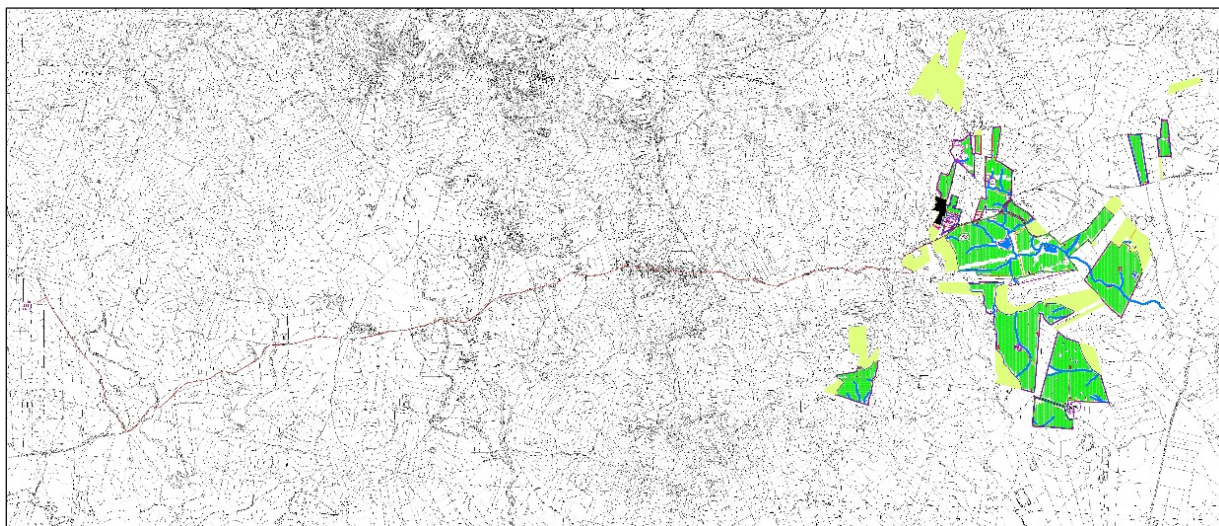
Area dell'Impianto con il tracciato del cavidotto di collegamento alla S.S.E. TERNA
